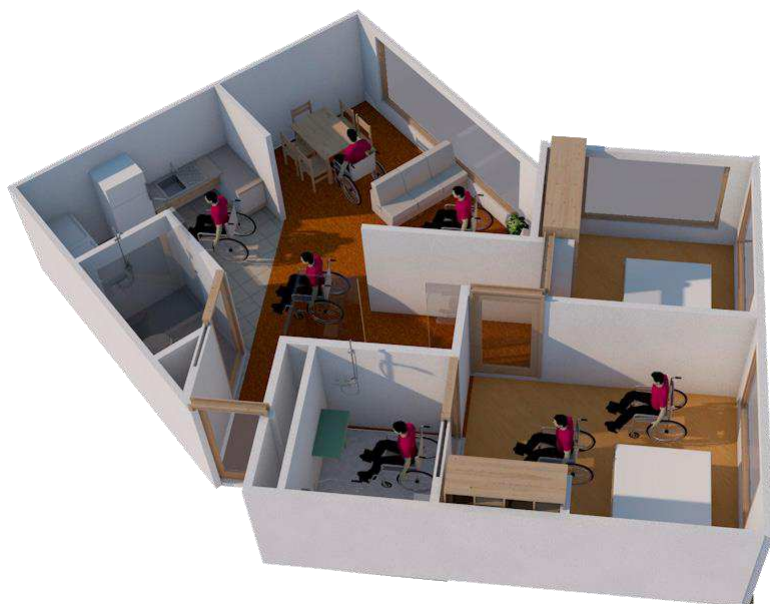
Planta tipo N. 3, Vista 3D, agrupación, planta técnica. Autor.
